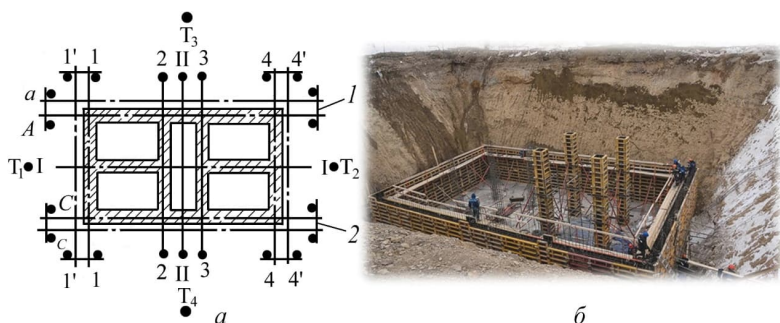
Розмічування та виконання котловану під фундамент споруди:
